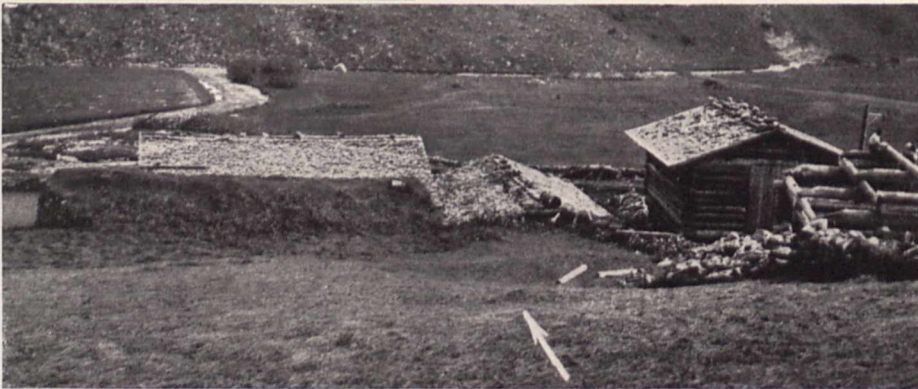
Guter und schlechter Lawinenschutz: die Gebäude links blieben verschont hinter der Lawinemauer, das rechts wurde zerstört; sein Lawinengeiler war zerfallen
